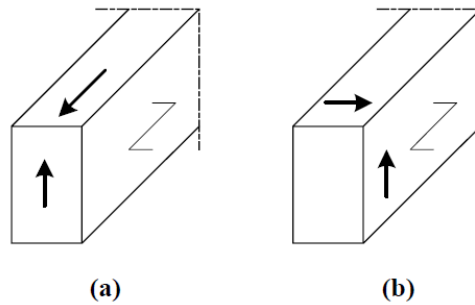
(a) elemento de madeira com uma componente de esforço transversal paralelo às fibras; (b) elemento de madeira com duas componentes de esforço transversal paralelas às fibras (rolling shear)
